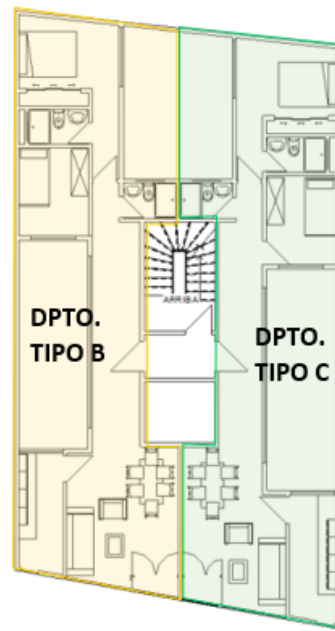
Plano de planta 2,3,4 y 5 – Dpto. Tipo B y C.
